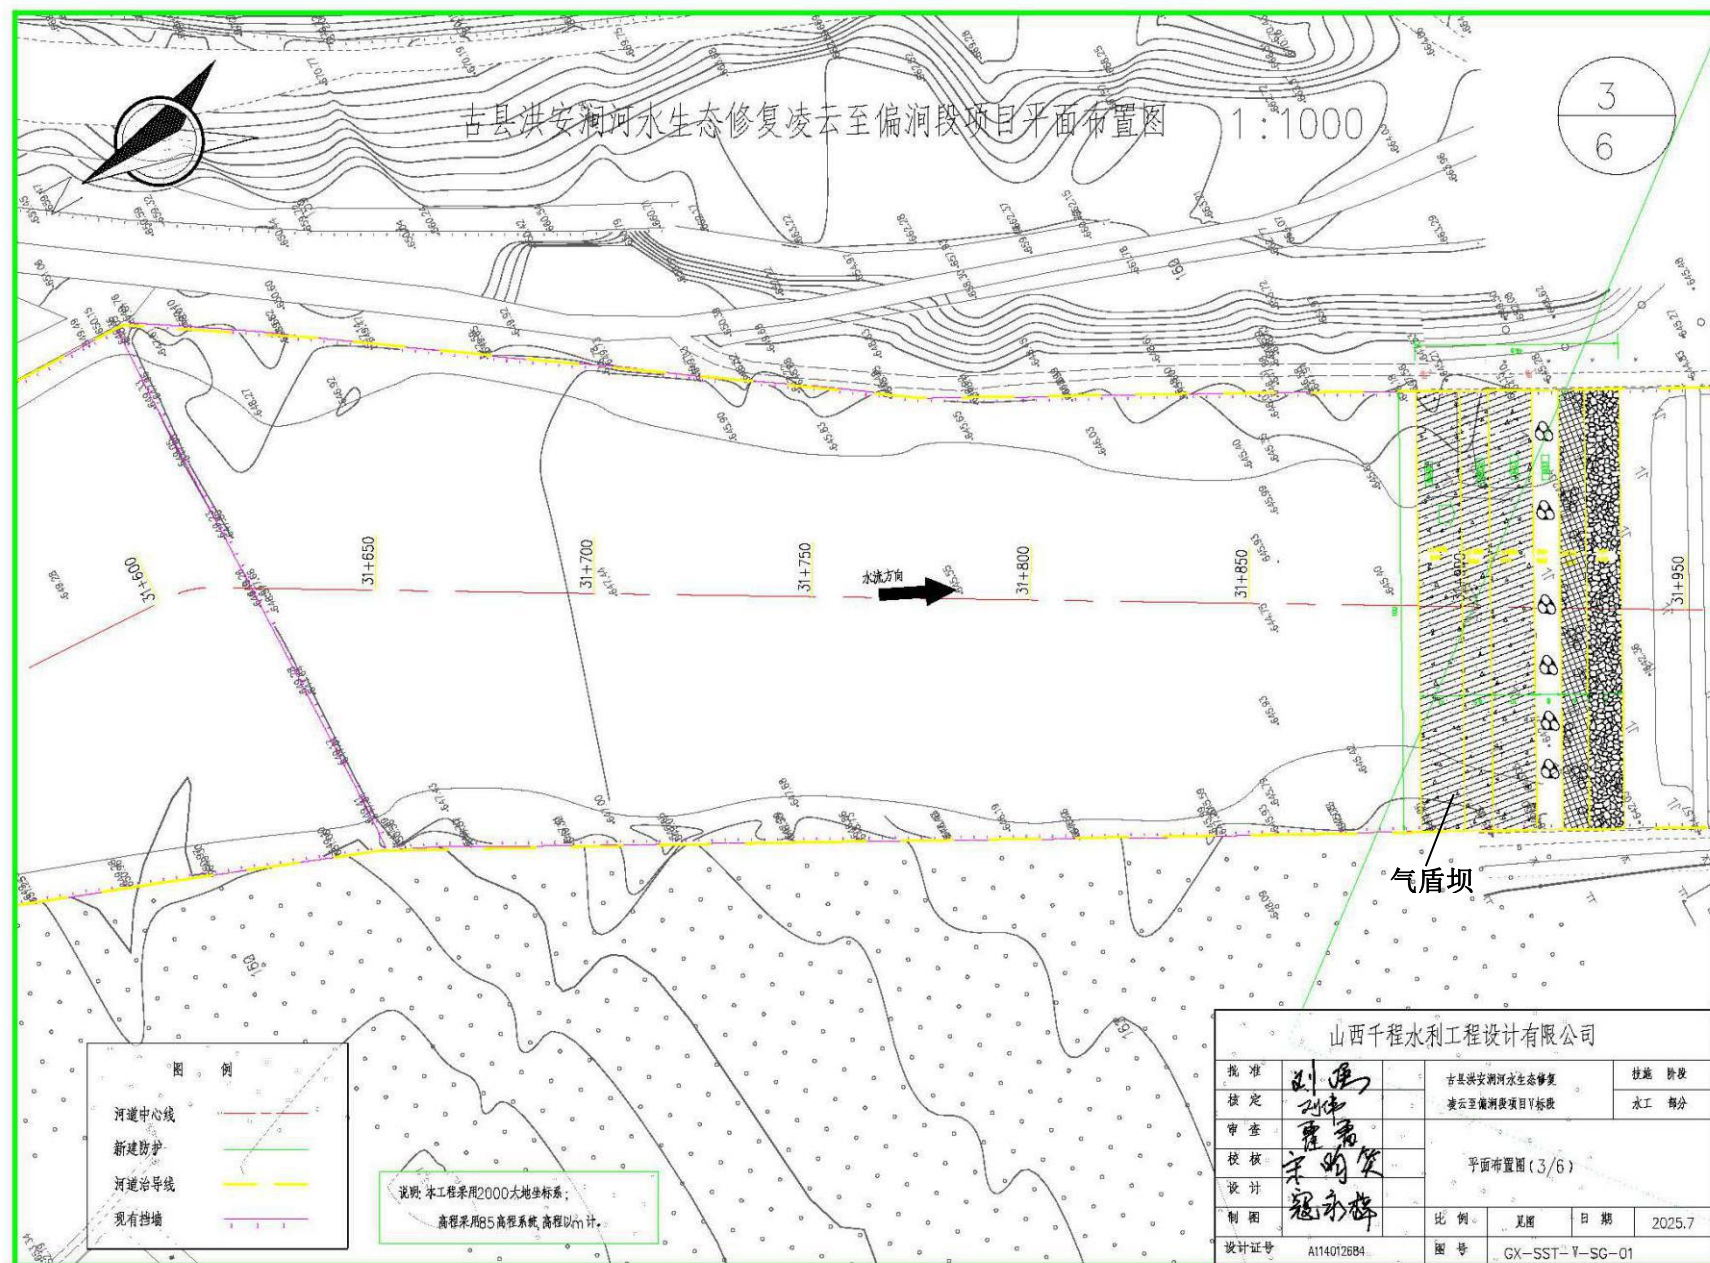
(16) 工程总平面布置图 (桩号 31+600-31+950)
